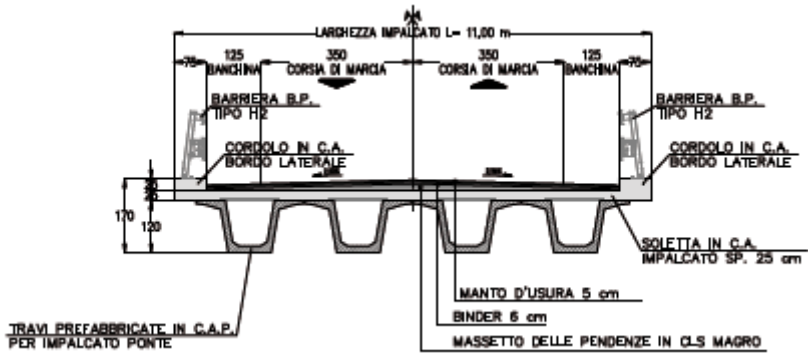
Sezione tipo opere in corrispondenza dell'attraversamento del fosso Paganico
